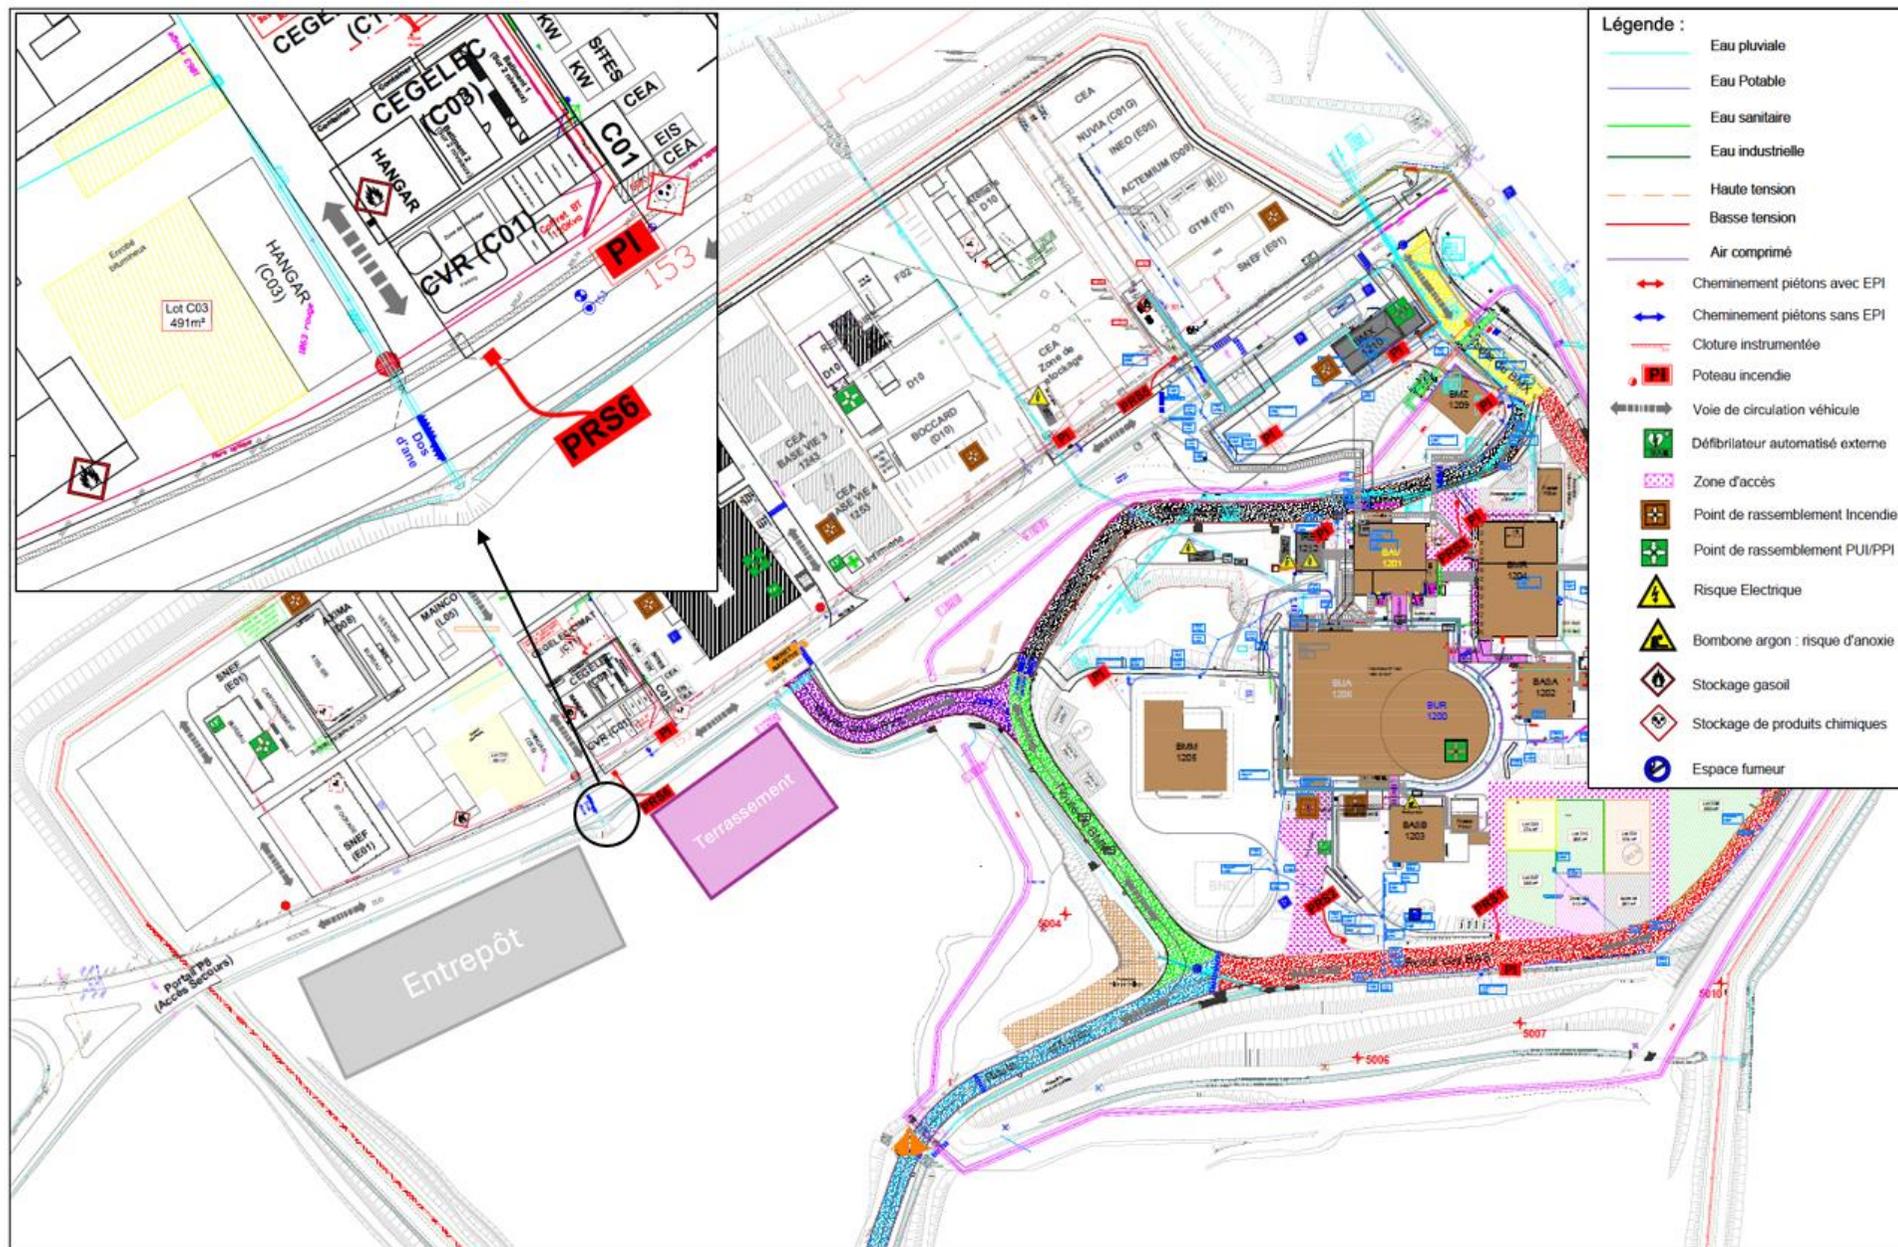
Plan détaillé, localisation de sortie des eaux pluviales (Source : CEA).
